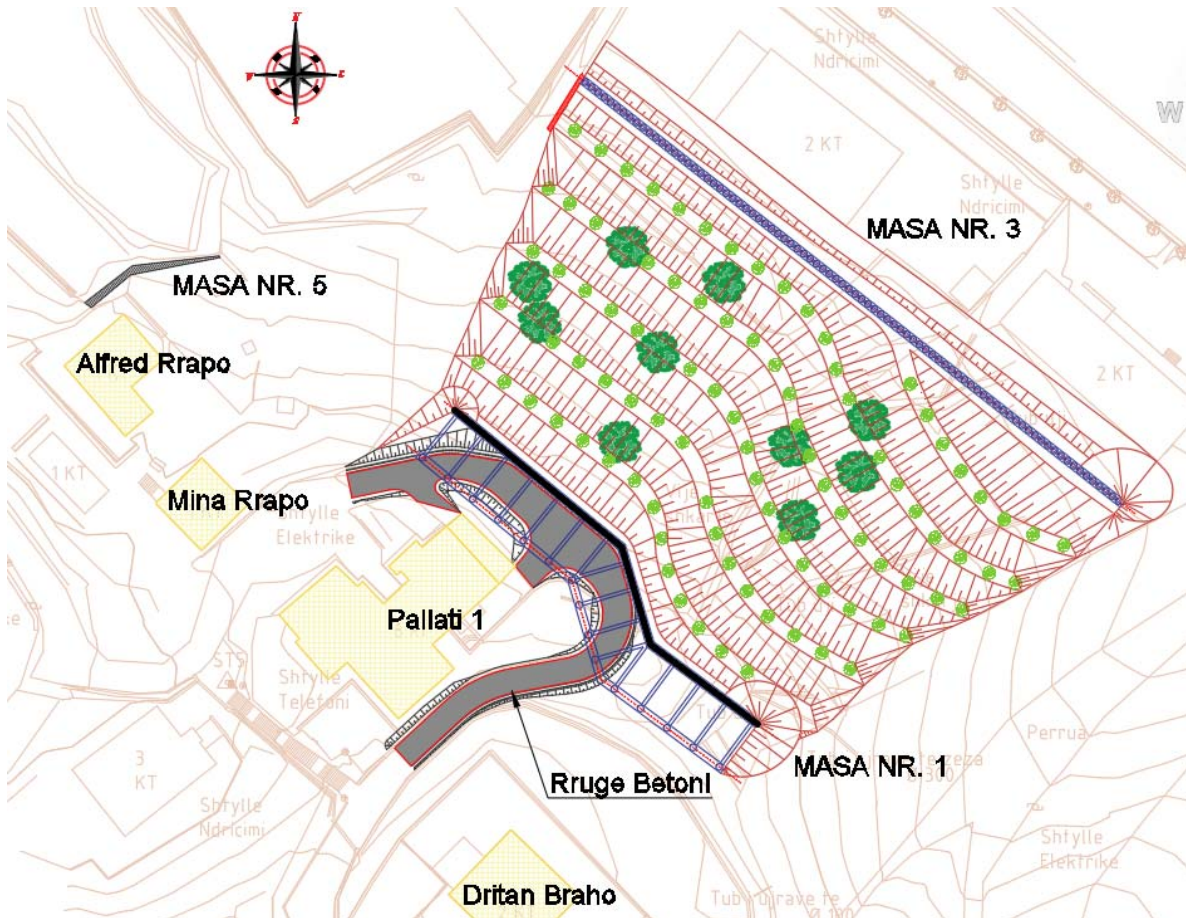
Plan i masave inxhinierike –Zona e rreshqitjes Nr. 1
